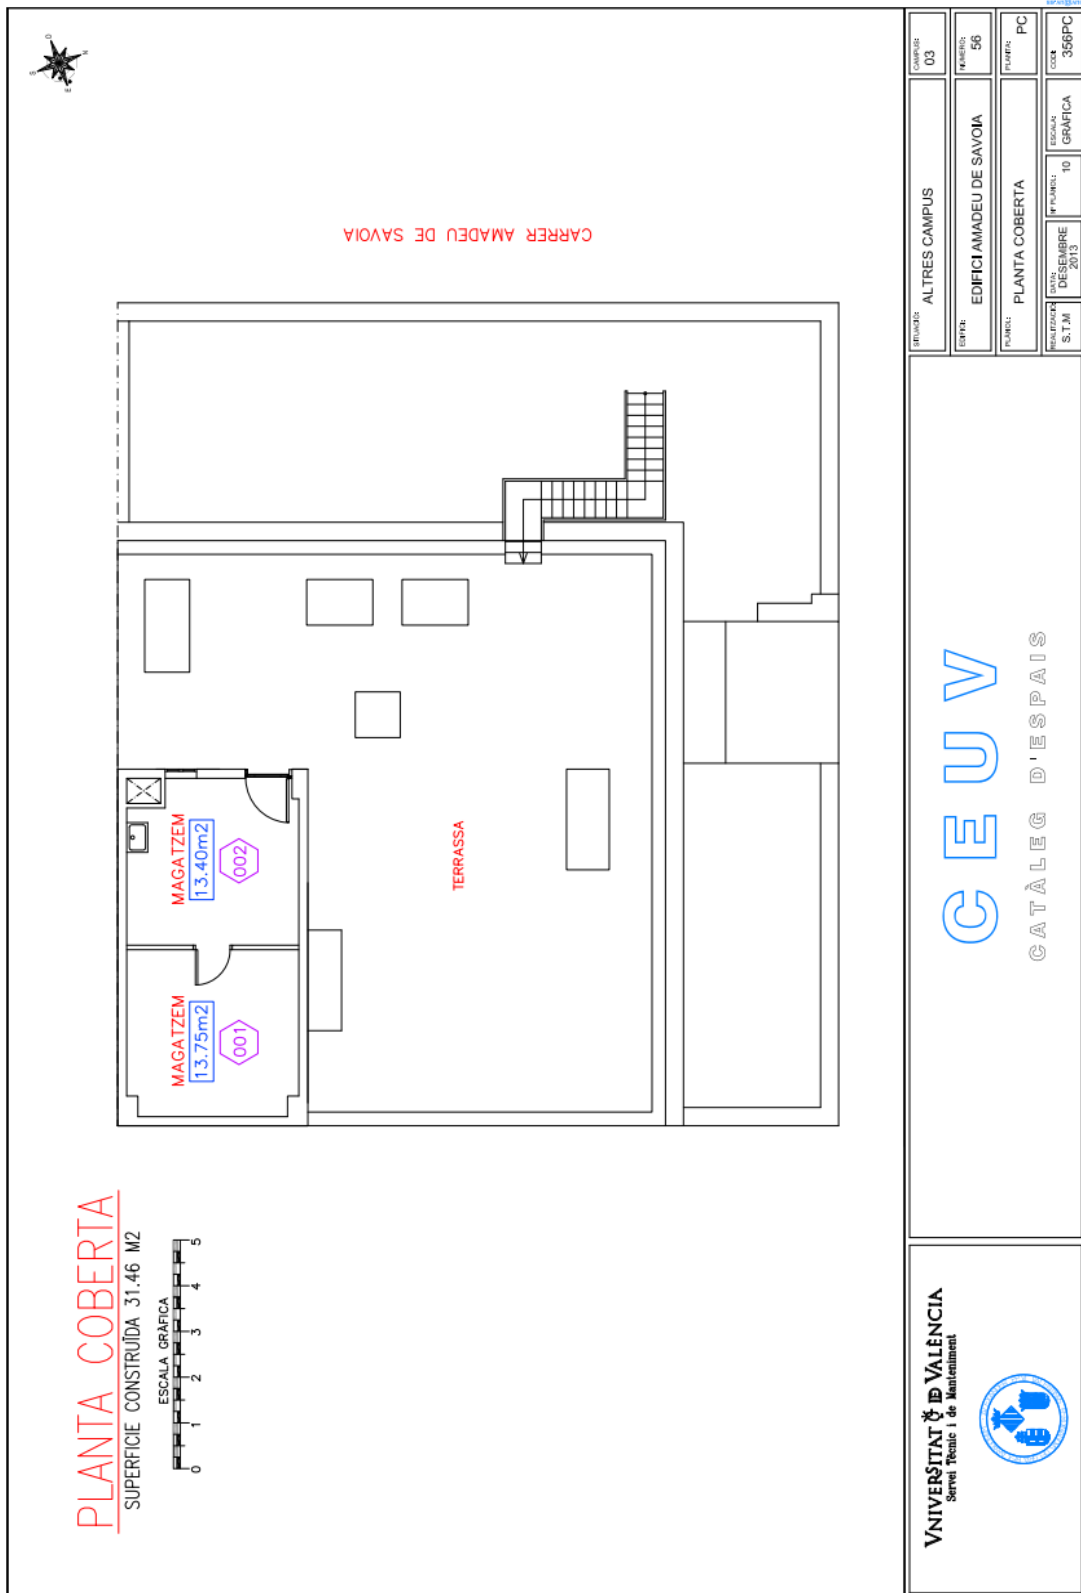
Plano de la planta cubierta del edificio Amadeo de Saboya (Universitat de Valencia, 2013)
